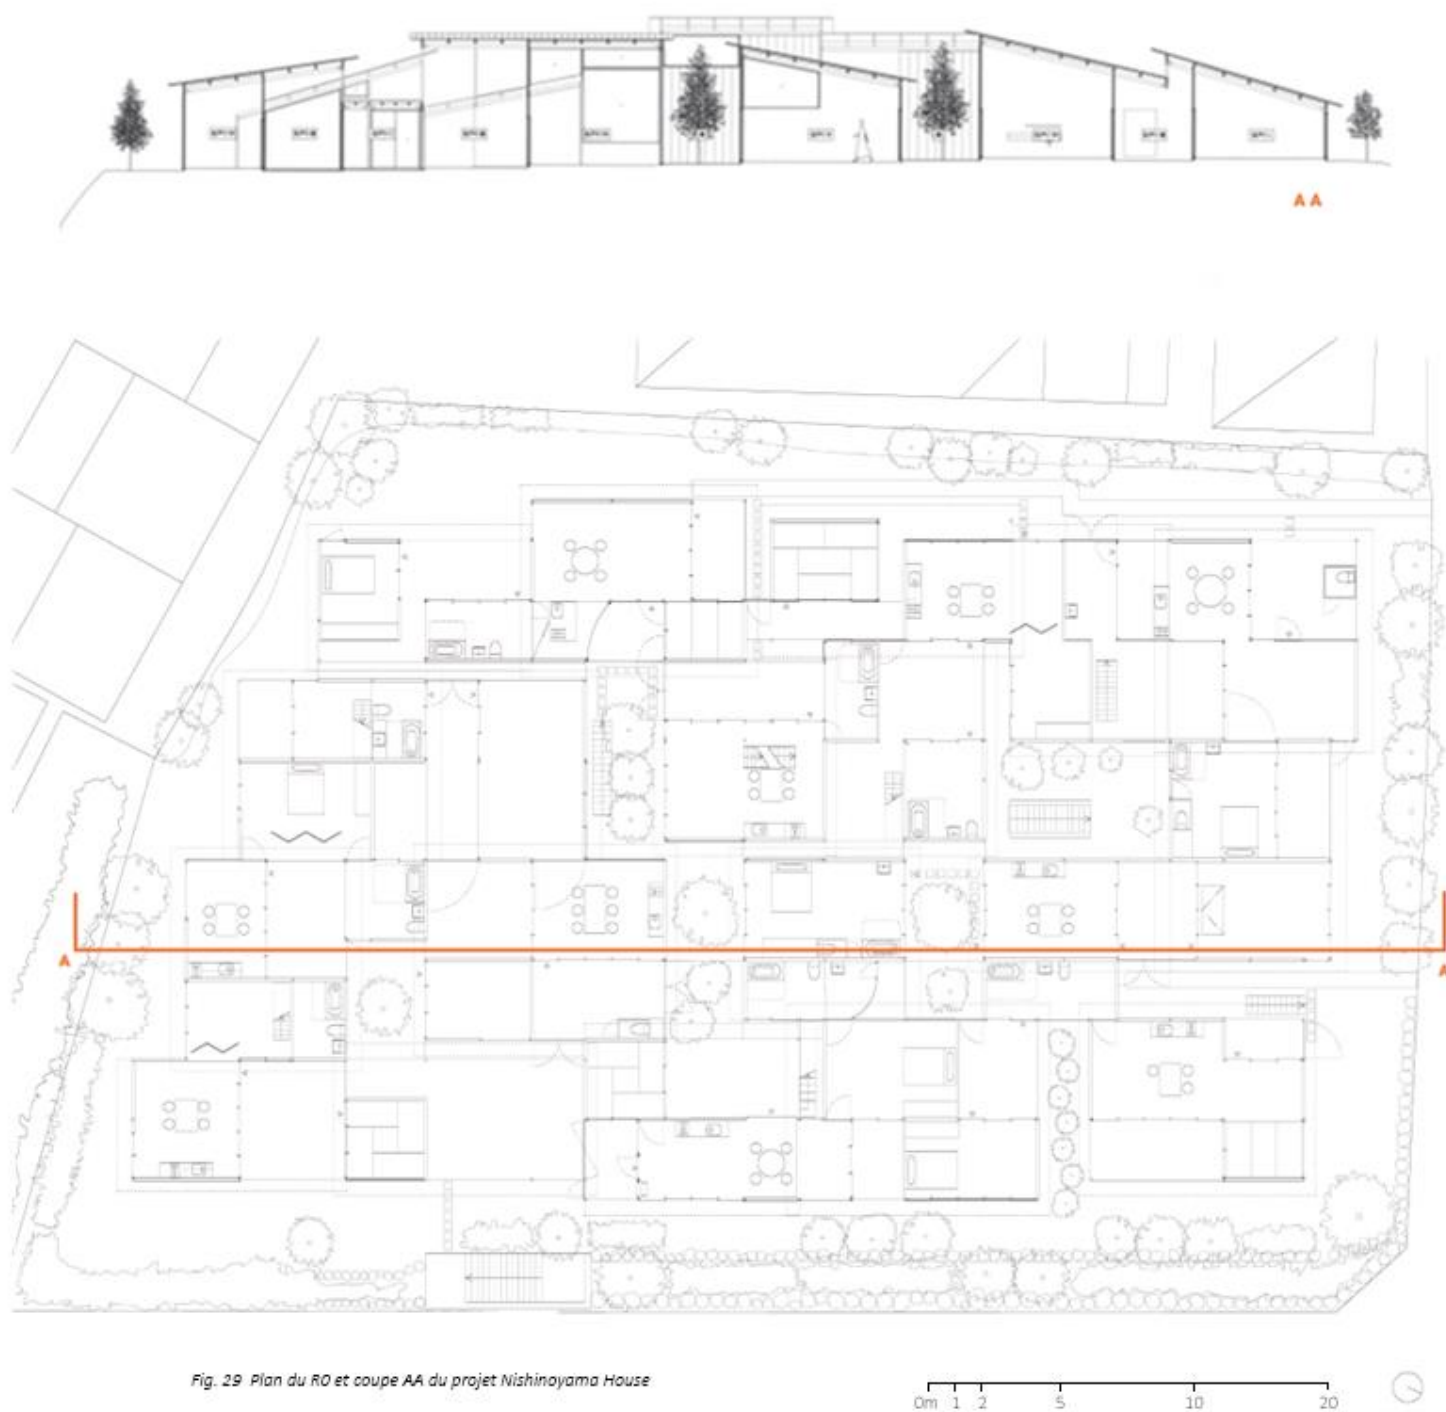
Plan du RO et coupe AA du projet Nishinoyama House
